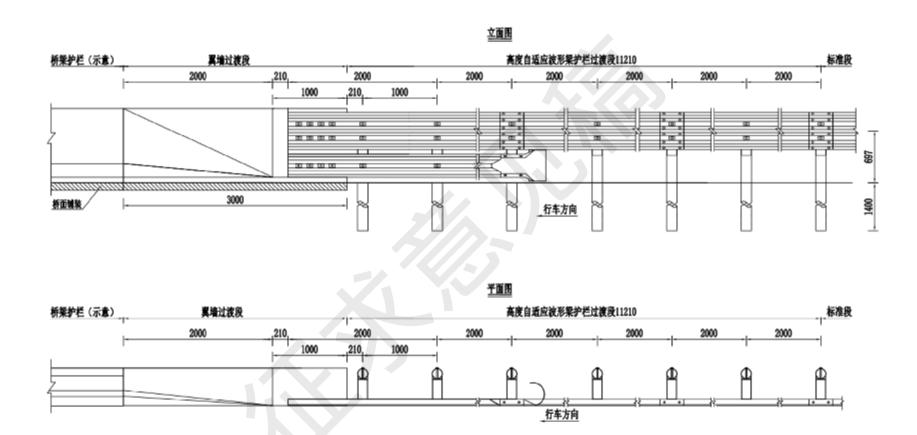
桥梁混凝土护栏与高度自适应波形梁护栏过渡段结构示例(尺寸单位: mm)
